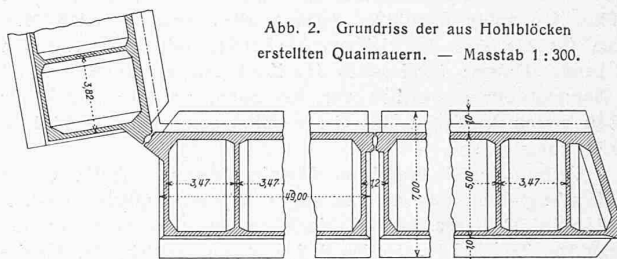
Grundriss der aus Hohlblöcken
